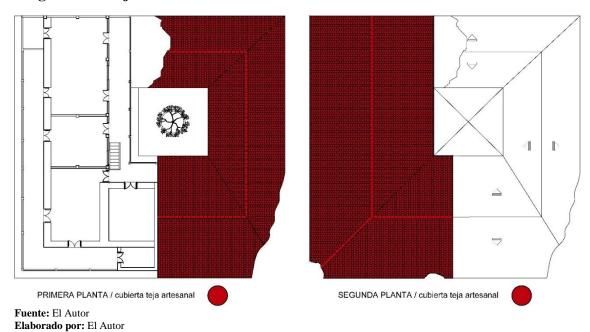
Teja artesanal como elemento constructivo vivienda familia Carrión
